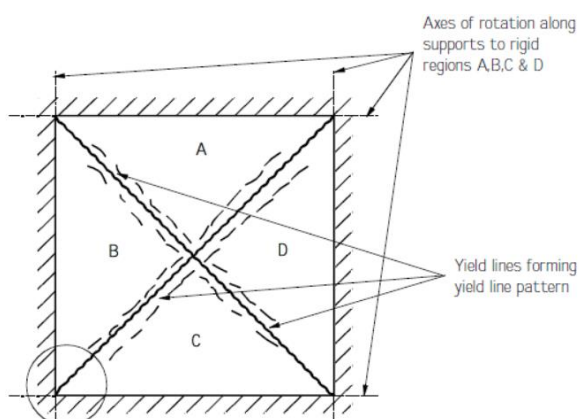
Mecanismo de rotura numa laje armada nas duas direções, simplesmente apoiada, após a cedência da armadura inferior [41].
